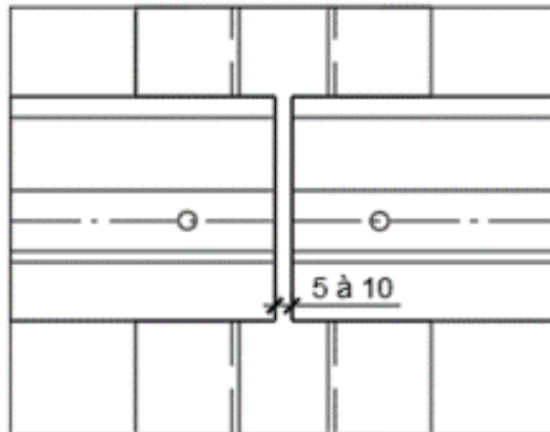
Détails fixations des rails horizontaux porteurs sur profilés en T
